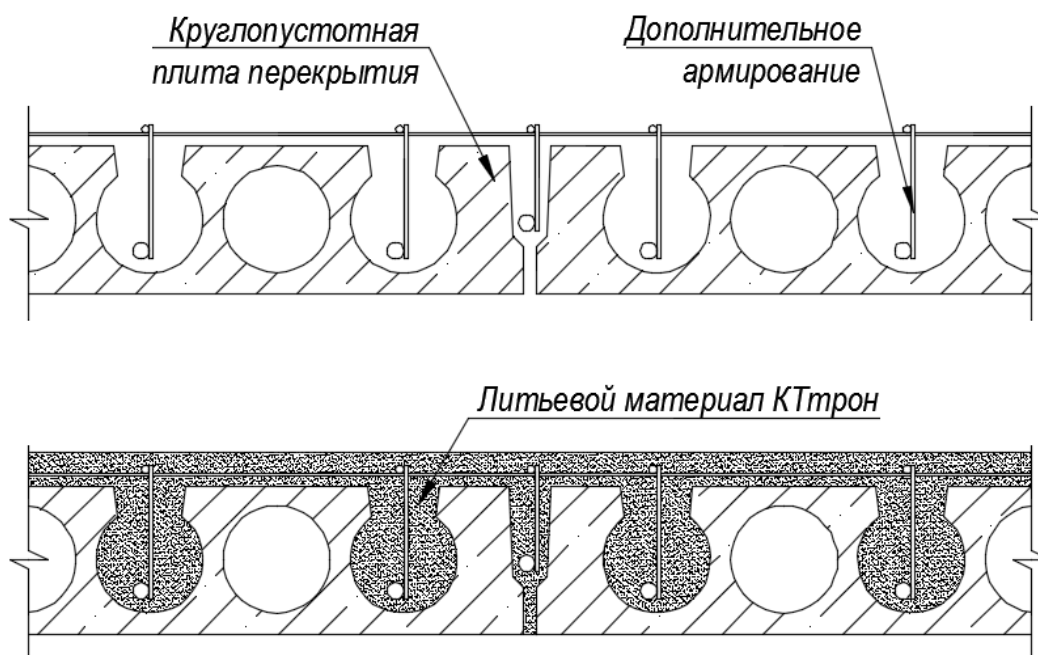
Ремонт круглопустотных плит перекрытия литьевым материалом «КТтрон»
